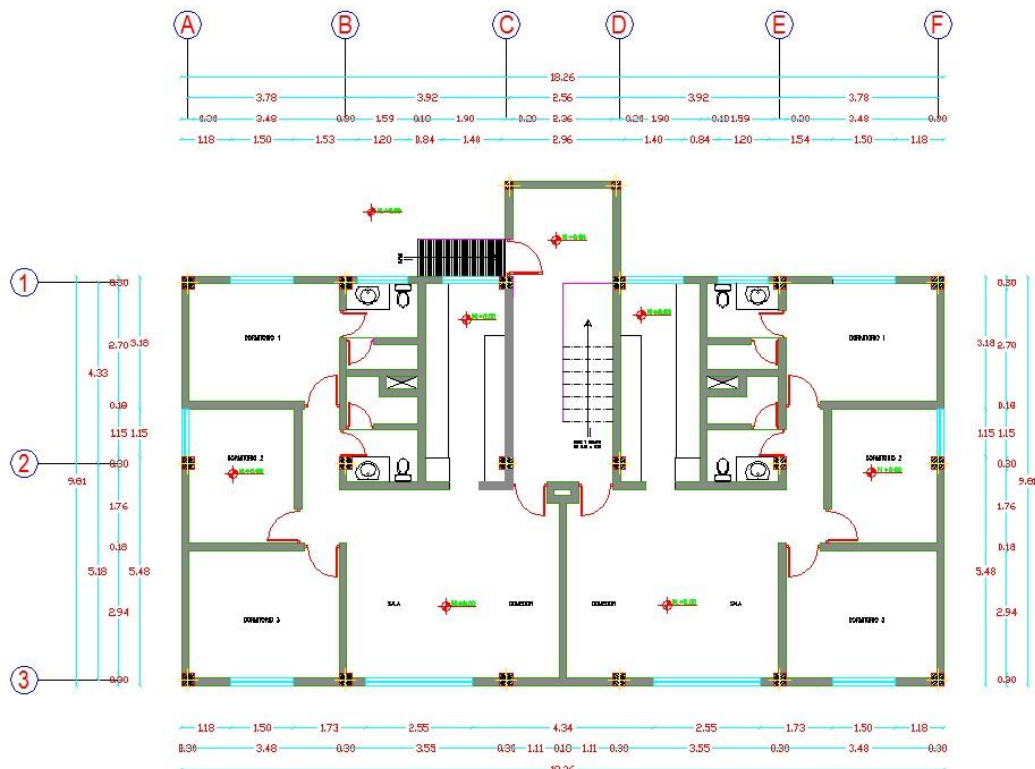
Levantamiento Arquitectónico Departamento Planta baja
